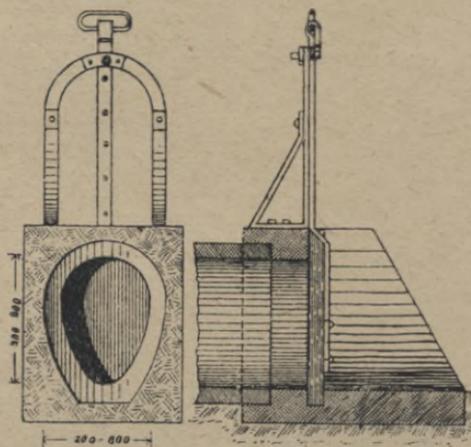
Schleusenstück mit festem Eisengerüst und Eichenholzschieber für eiförmige Rohre.
